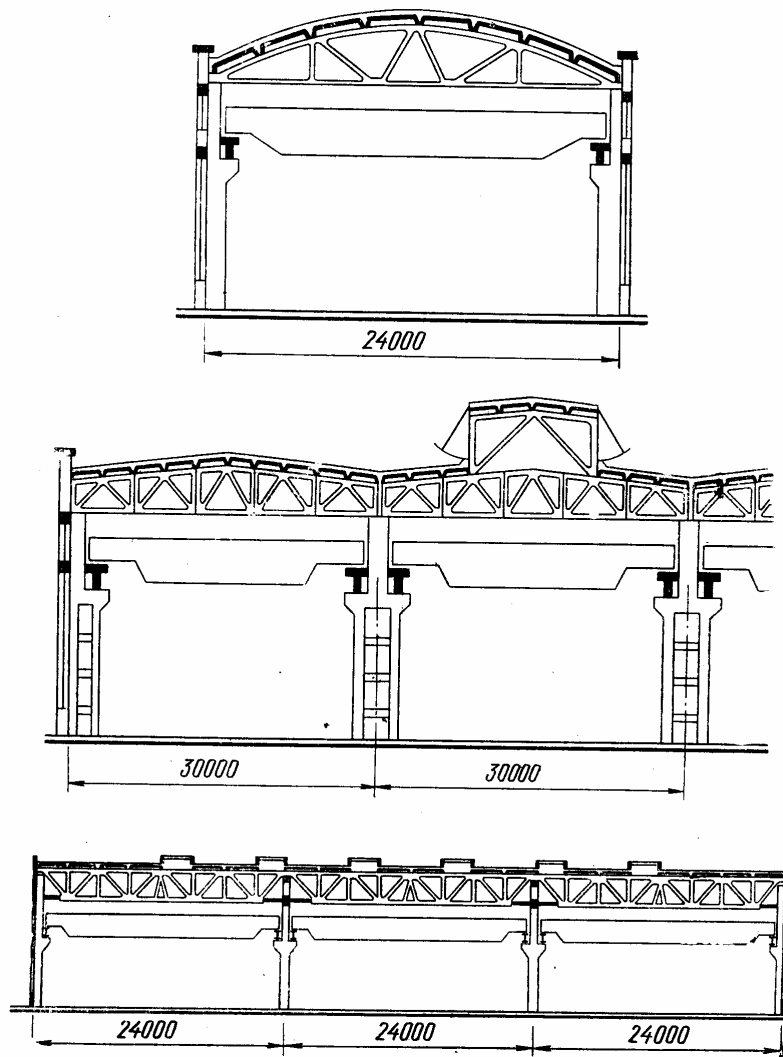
Схемы поперечных разрезов однопролетного и многопролетных зданий
